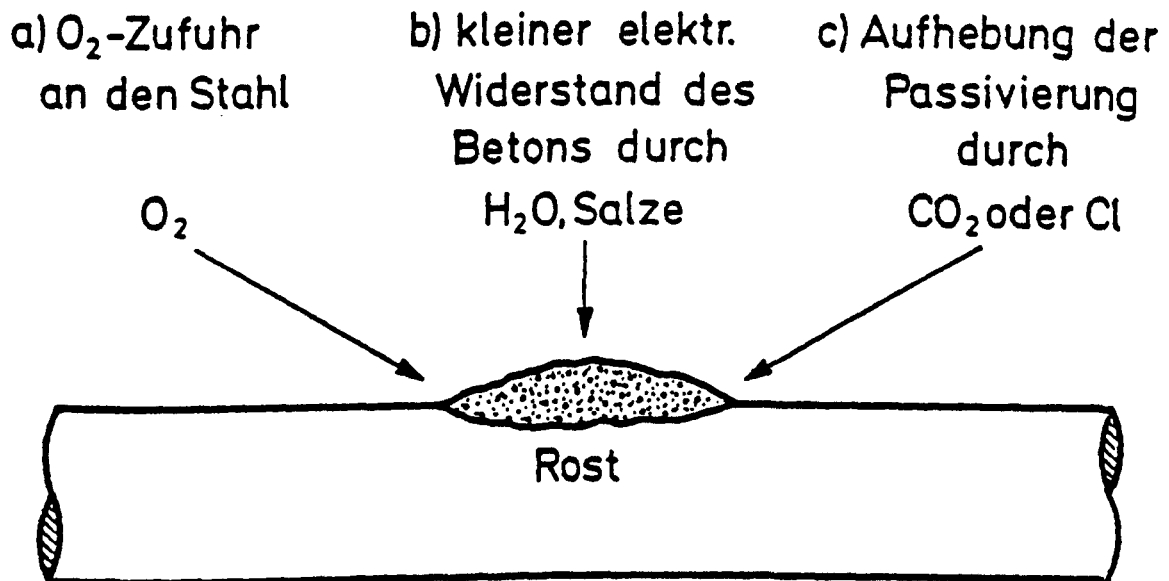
Gleichzeitig zu erfüllende Voraussetzungen für die Korrosion eines Bewehrungsstahles im Beton
